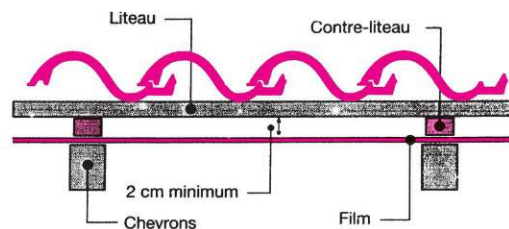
Écran étanche sous-toiture avec ventilation sous les tuiles par lame d'air d'épaisseur minimale de 2
